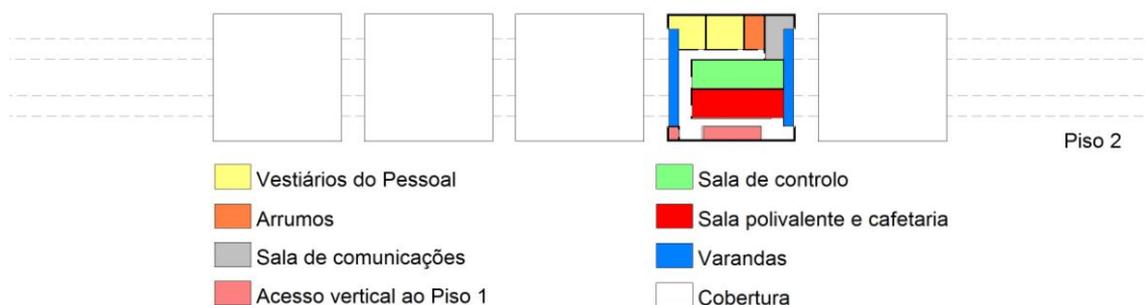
Estação proposta da Zona Franca Litoral- planta geral do Piso 2
